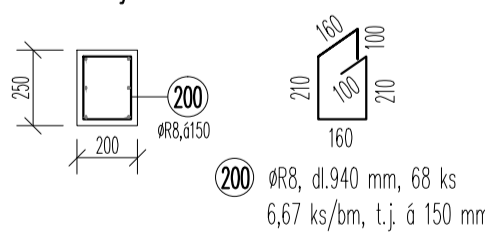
DETAIL vyztužení nároží schod. stěny – 23,3 bm
